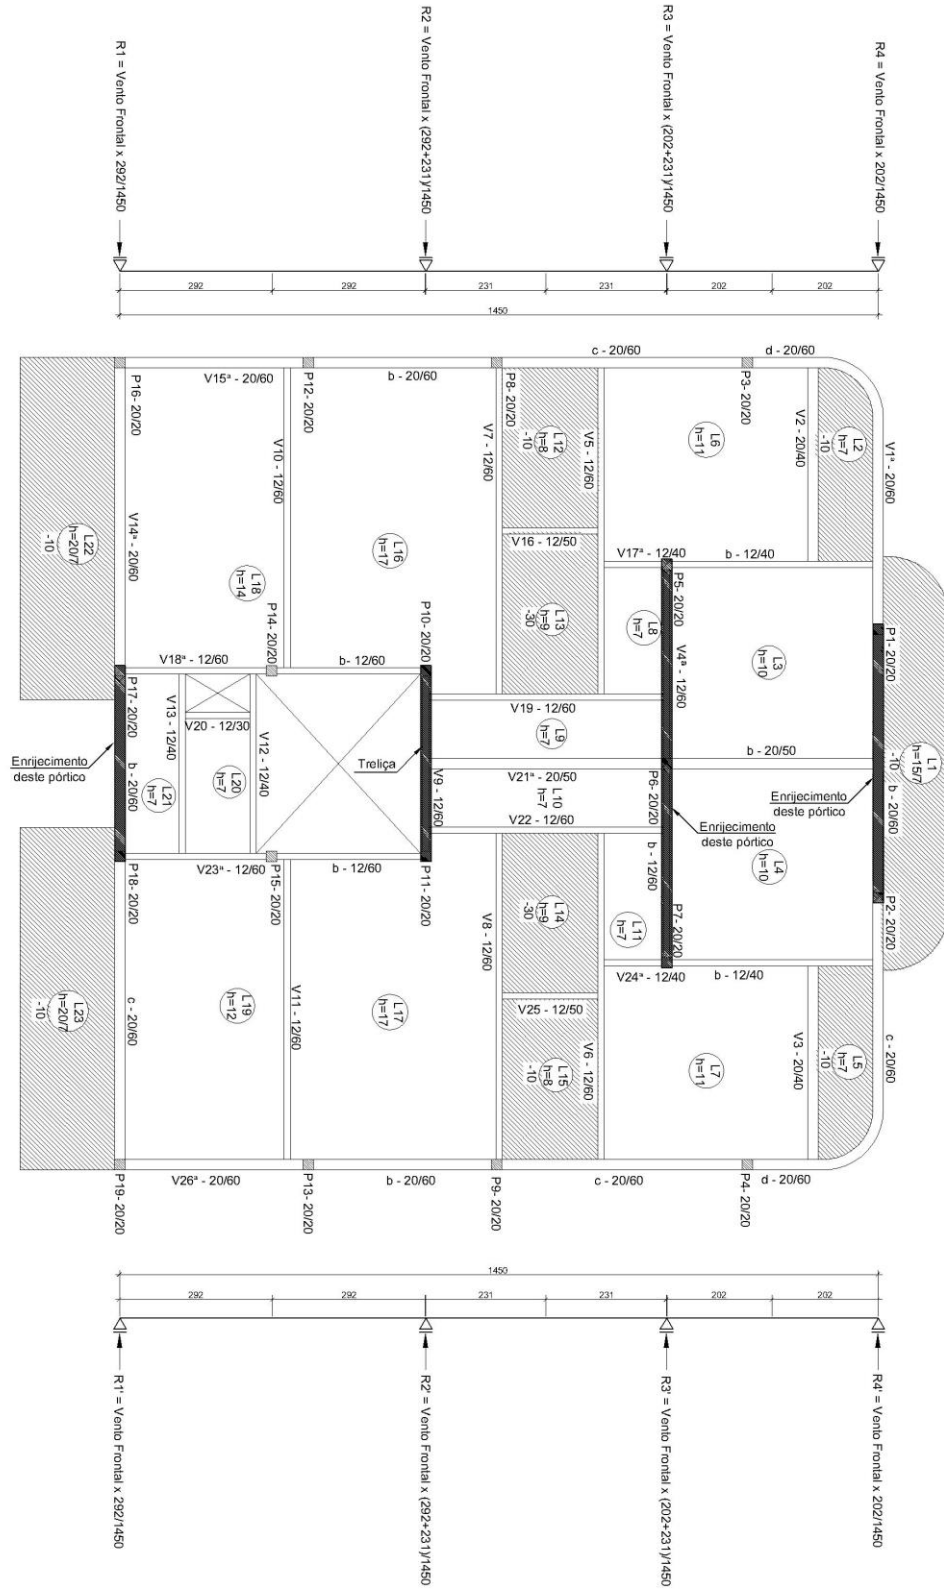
Cargas de vento distribuidas para cada pano de laje na fachada maior.
